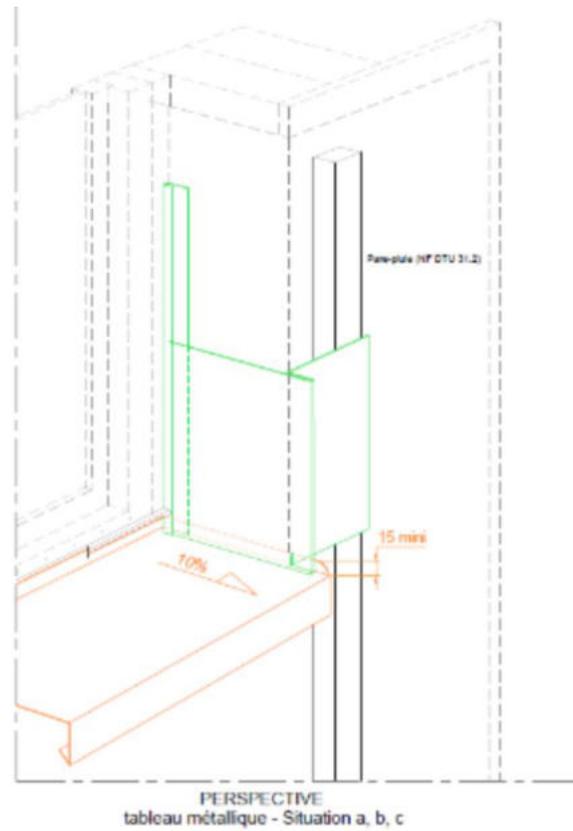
Pose sur COB - Dispositions particulières du traitement des baies (Menuiserie en tunnel intérieur)
